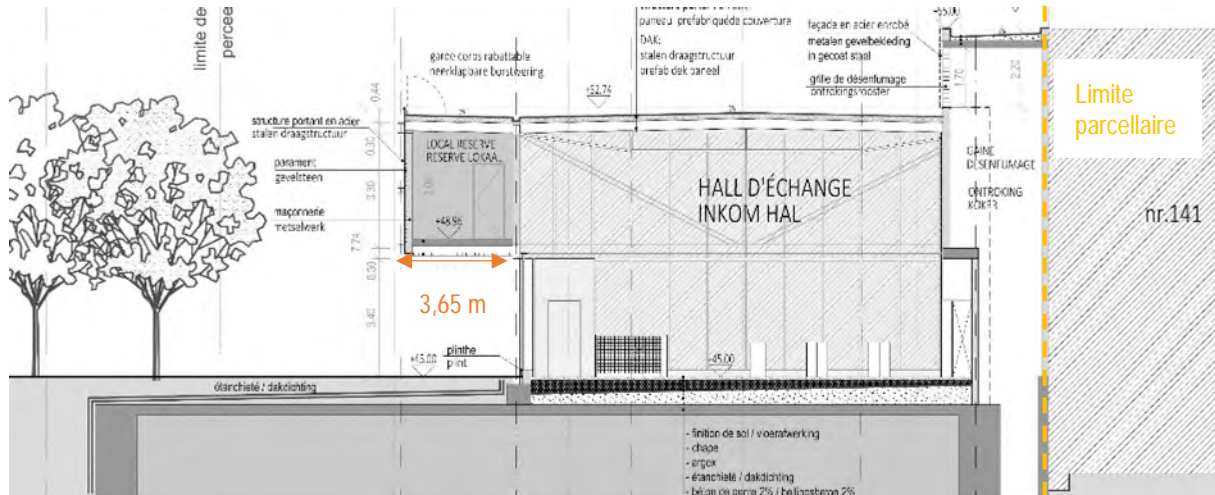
Coupe transversale (ARIES sur fond BMN, 2018)
